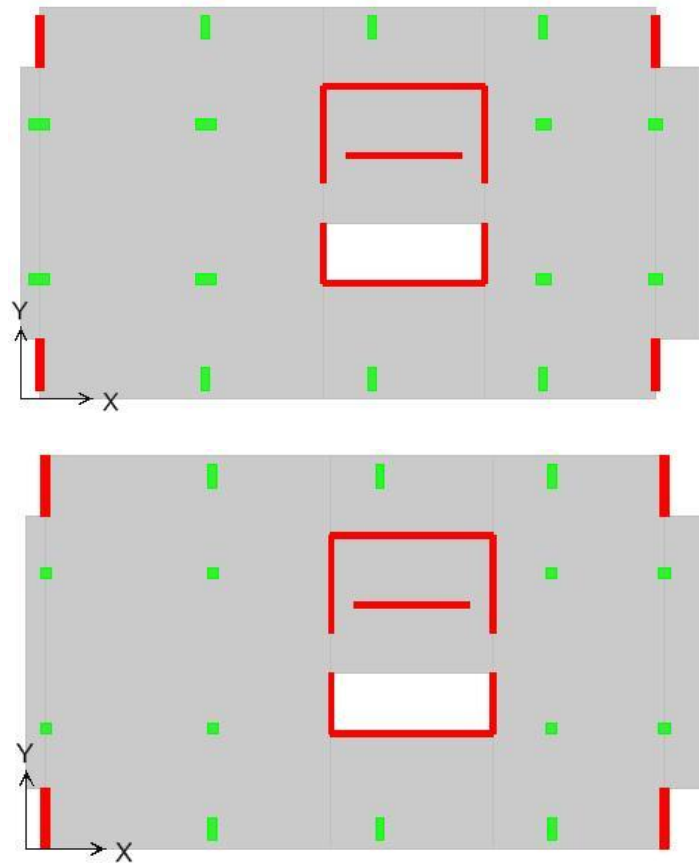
Planta primer piso (arriba) y piso tipo (abajo) edificio O4
